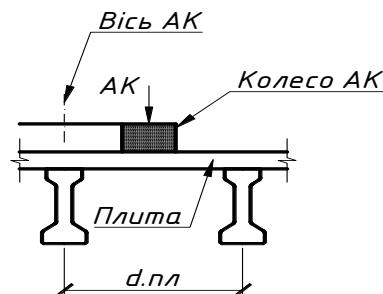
Схема навантаження плити однією смugoю A-11
